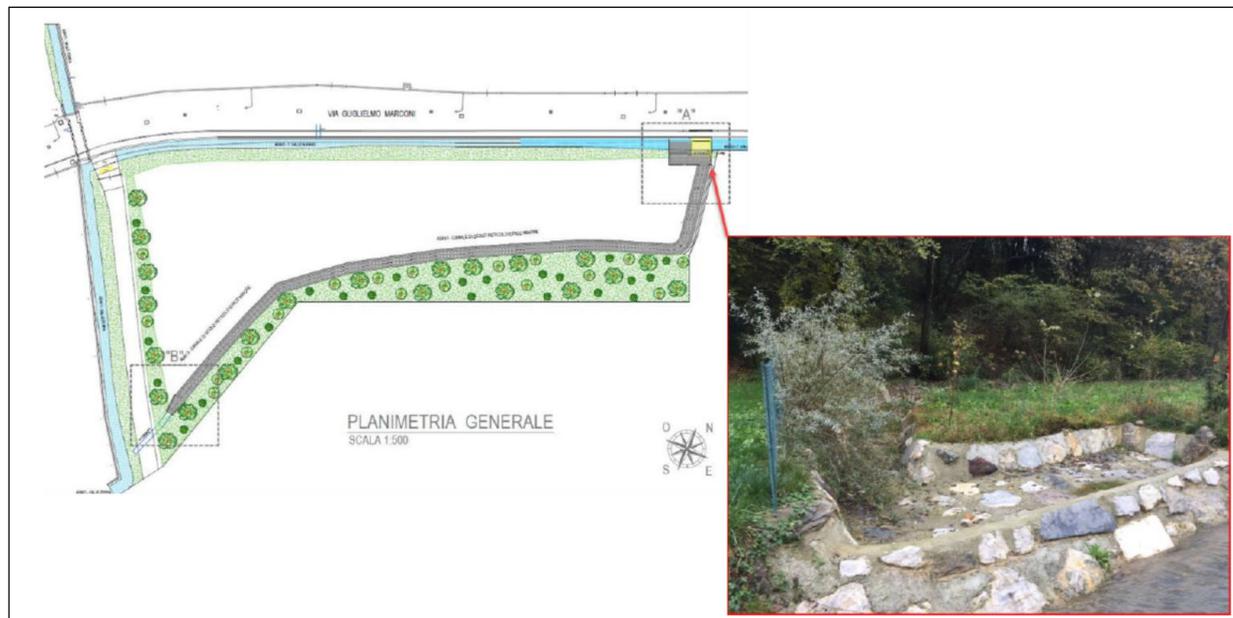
Planimetria generale dell'intervento sul T. Valle d'Albano e particolare della soglia di attivazione.
